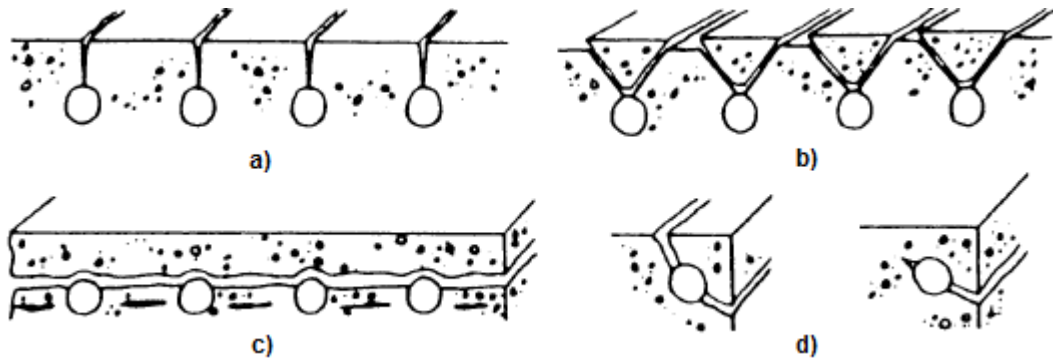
Deterioração do betão: a) Fissuração; b) Descamação; c) Delaminação; d) Quebras nos cantos [26]
